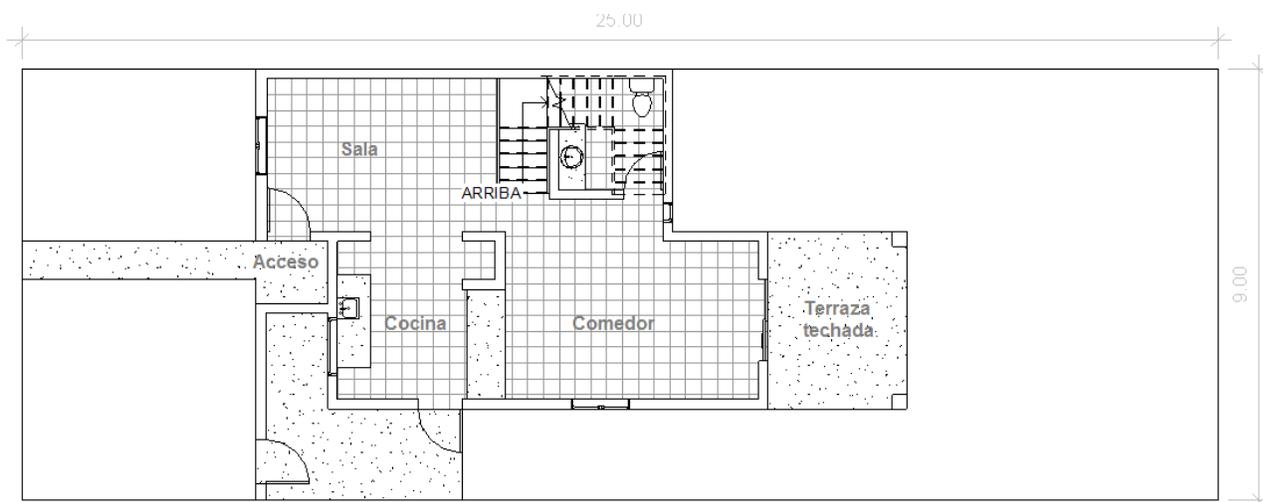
Croquis de vivienda tipo media, en planta baja
